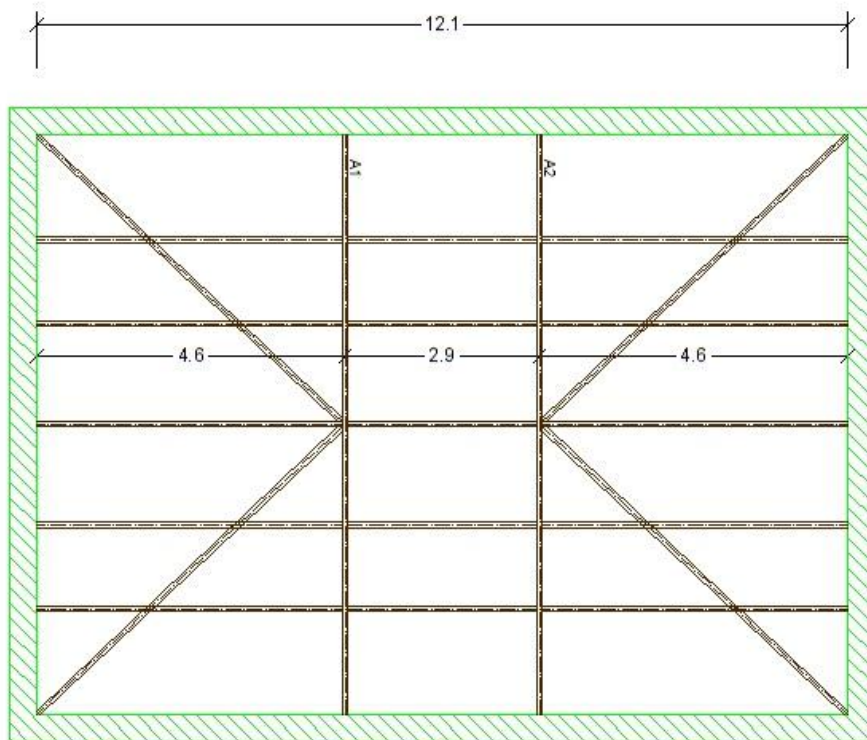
Planta estrutural do nível 2 (cobertura)
